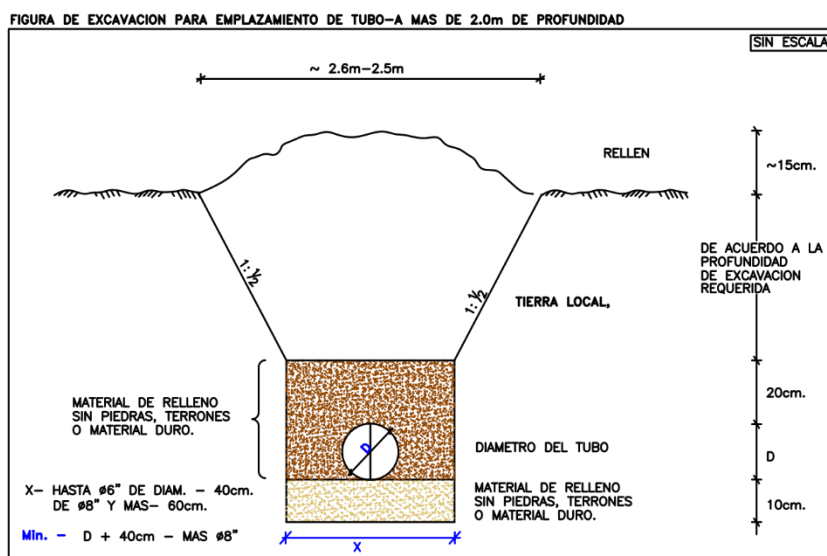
Esquema de emplazamiento de tuberías en caminos primarios. Elaboración Propia
